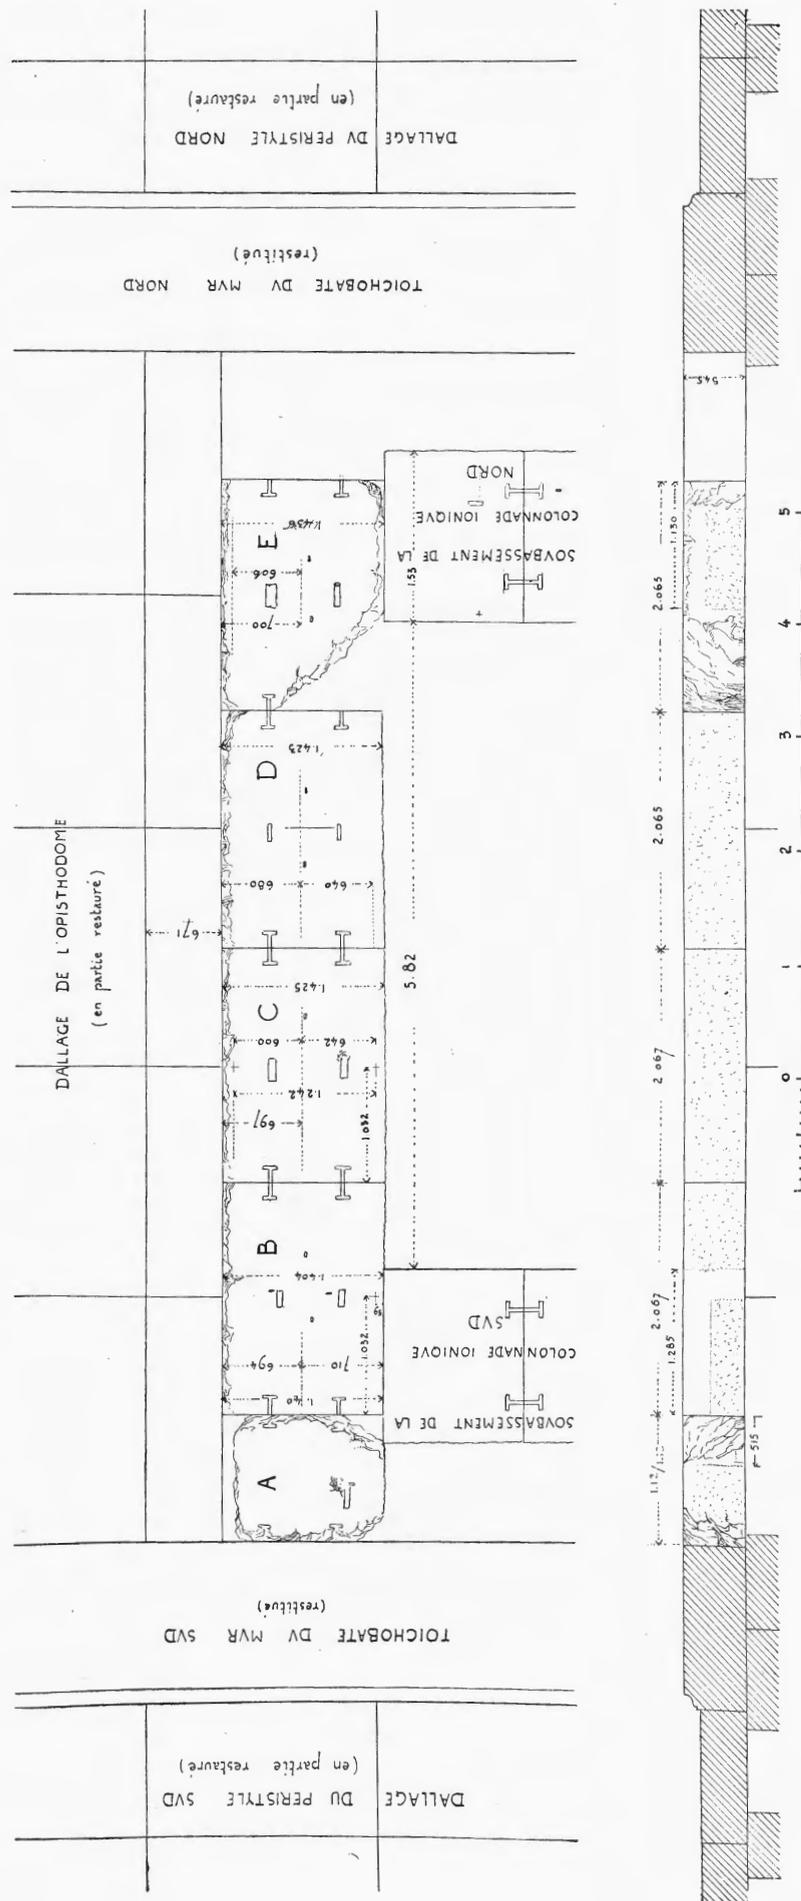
Plan et élévation interne du toichobate du mur Ouest de la cella.
